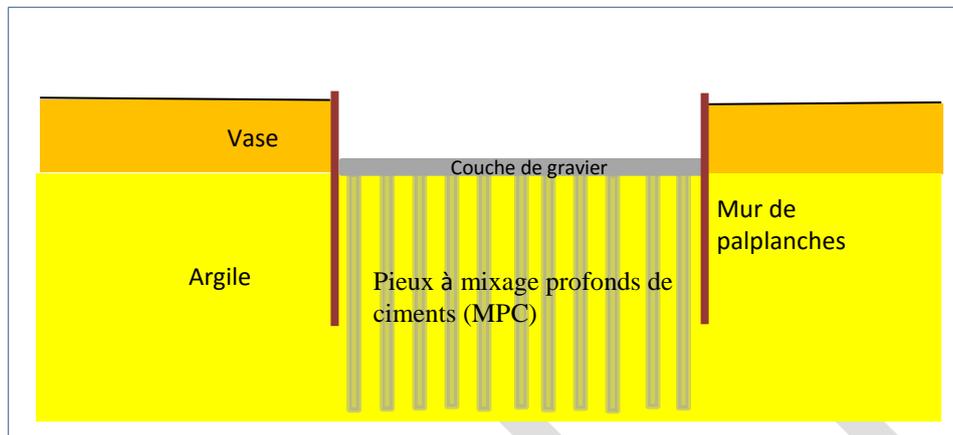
Placement de la chape de gravier au fond de la tranchée.
